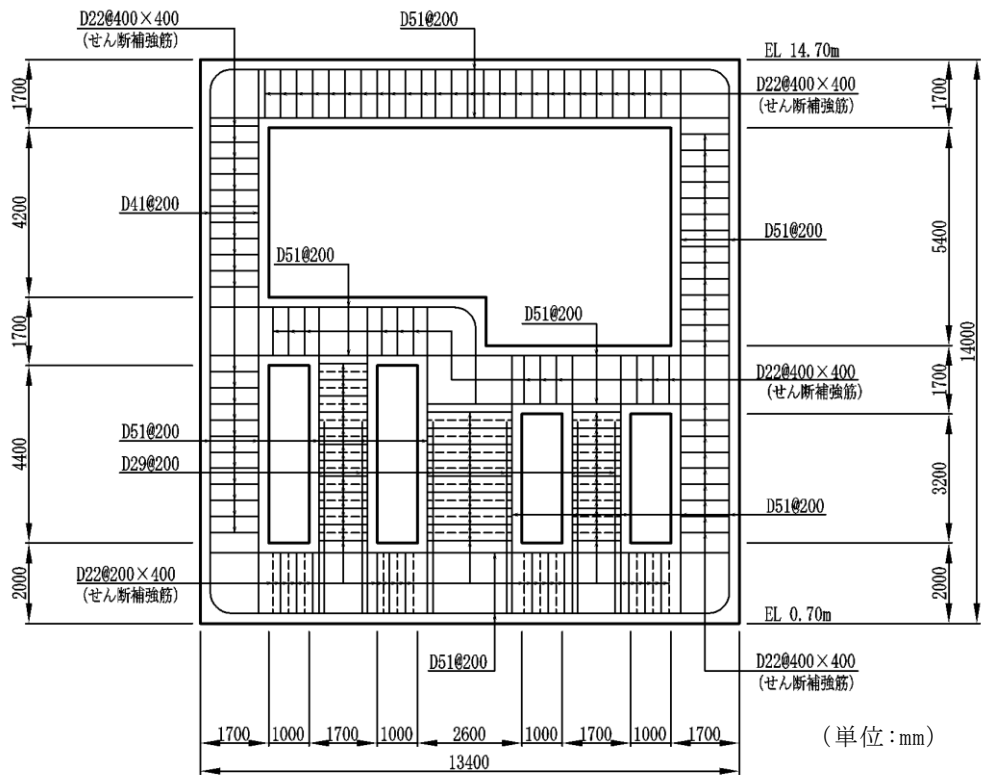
第 1 ベントフィルタ格納槽概略配筋図 (B-B 断面)
